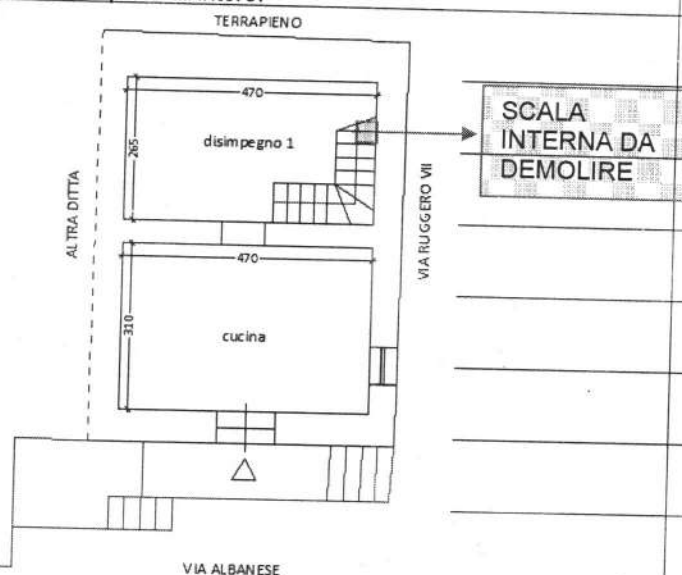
LOTTA B - Pianta piano terra STATO DI FATTO
